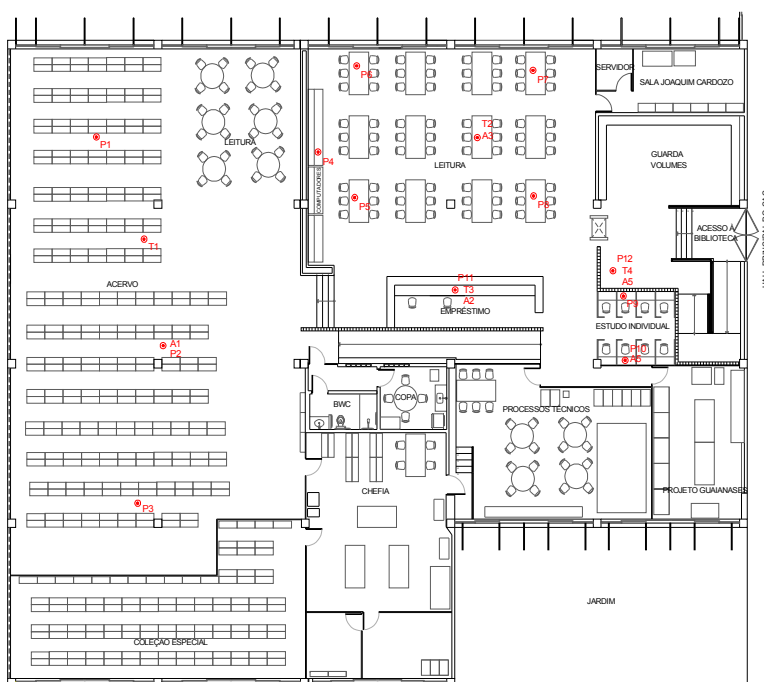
Planta baixa da biblioteca com as indicações dos pontos de medições de conforto.
